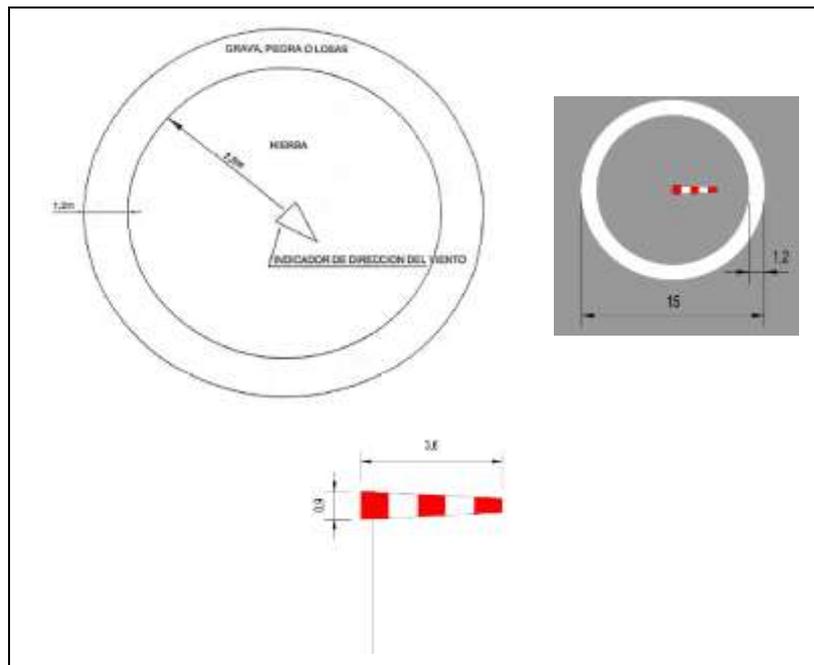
Detalle emplazamiento del indicador de la dirección del viento
